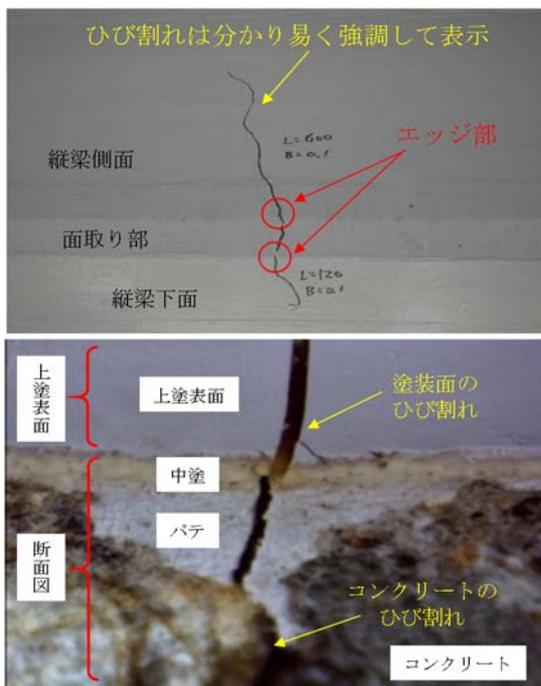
縦梁 Ae 種の塗膜ひび割れ
